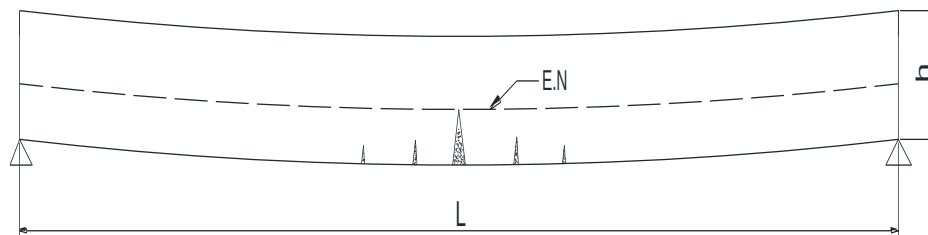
Falla a tensión de tracción del Concreto. Fuente Propia
